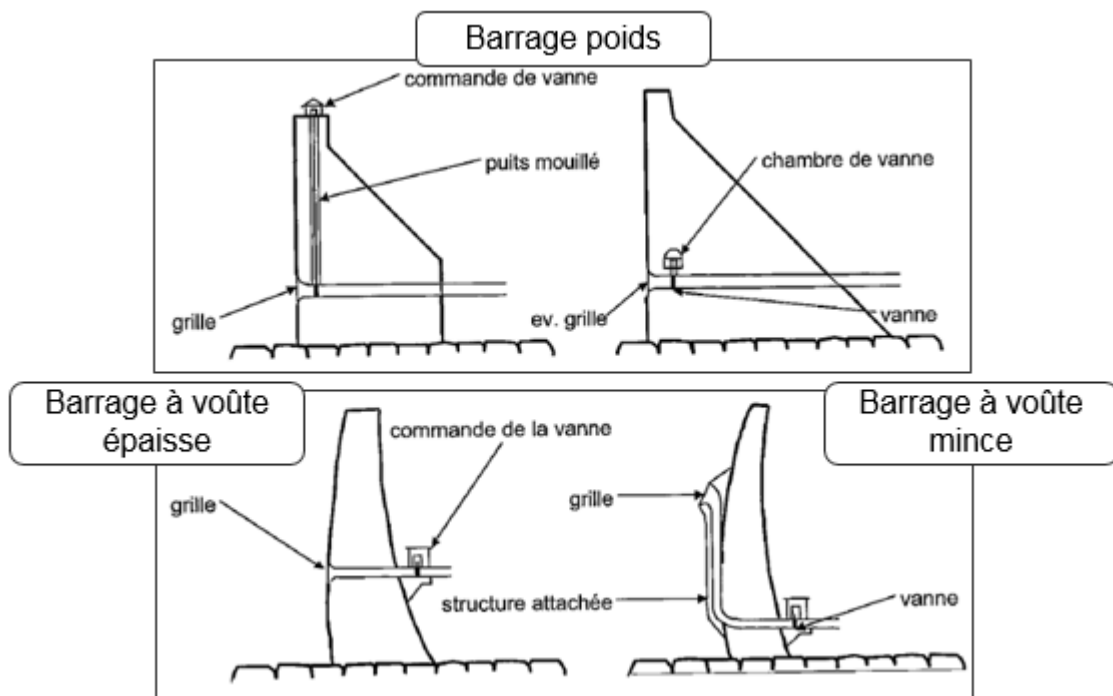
Schéma d'une installation de prise d'eau combinée avec différents types de barrage
